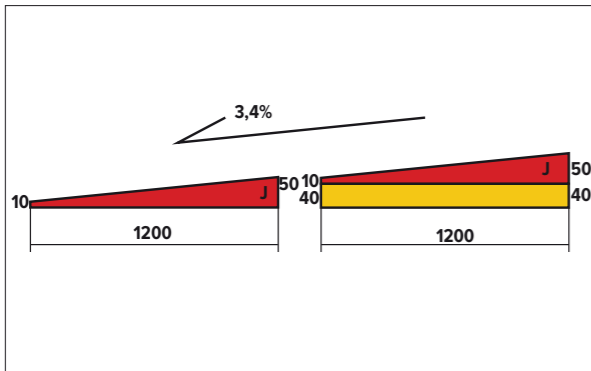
Схема укладки контруклона PIR SLOPE 3,4%
